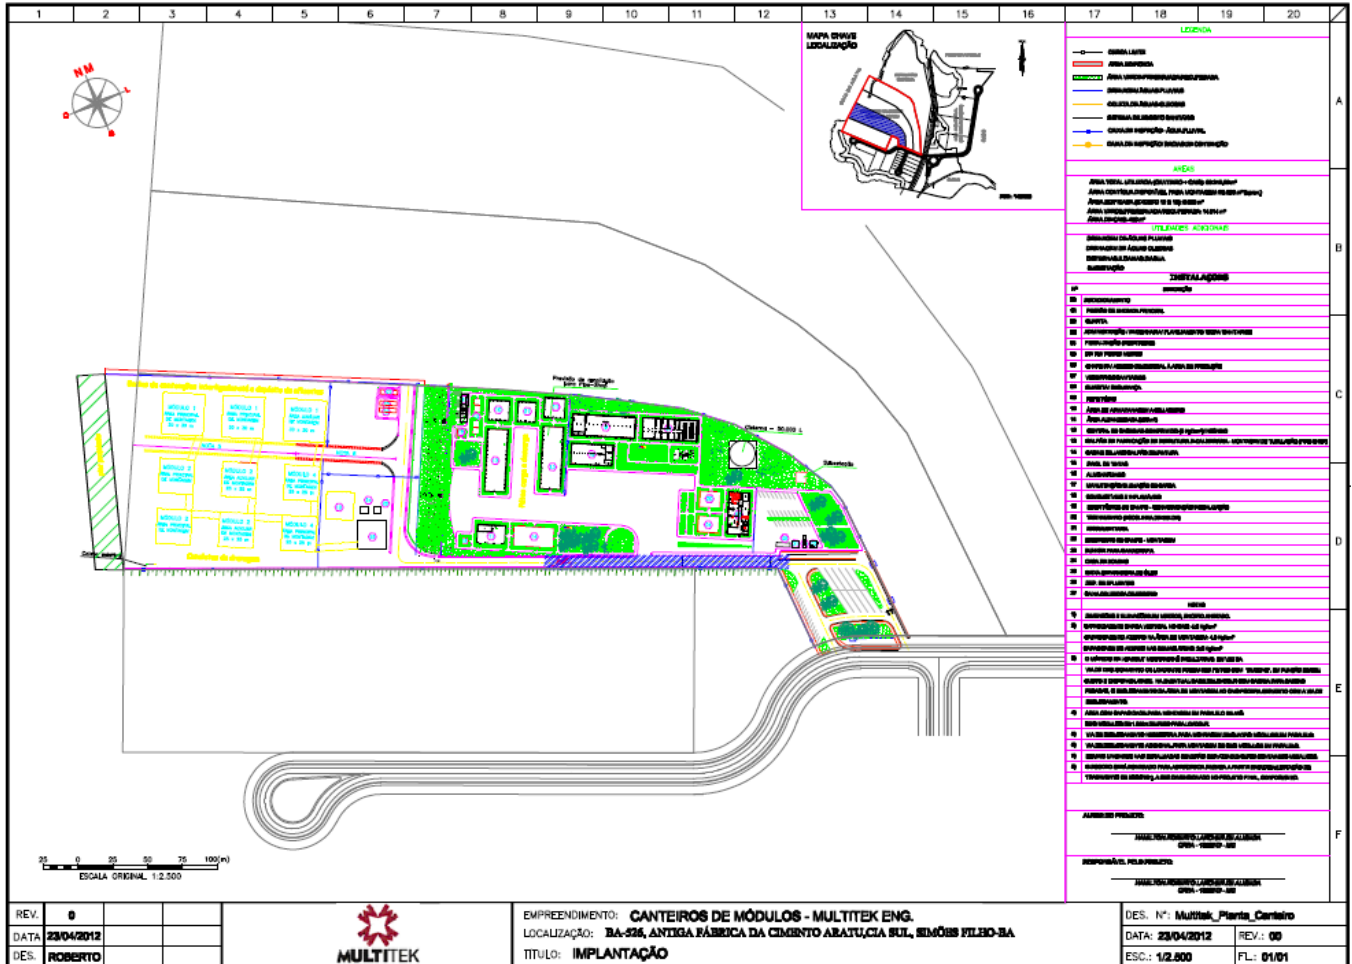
Planta de implantação da MULTITEK (Anexo 2.5)
